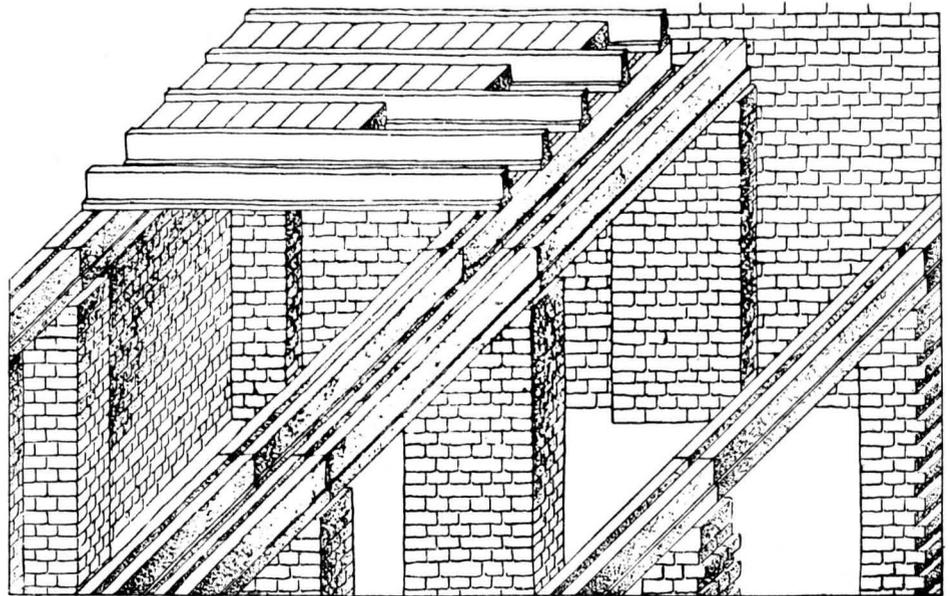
Schaubild einer Kellerecke mit teilweise eingebrachter Konstruktion.
